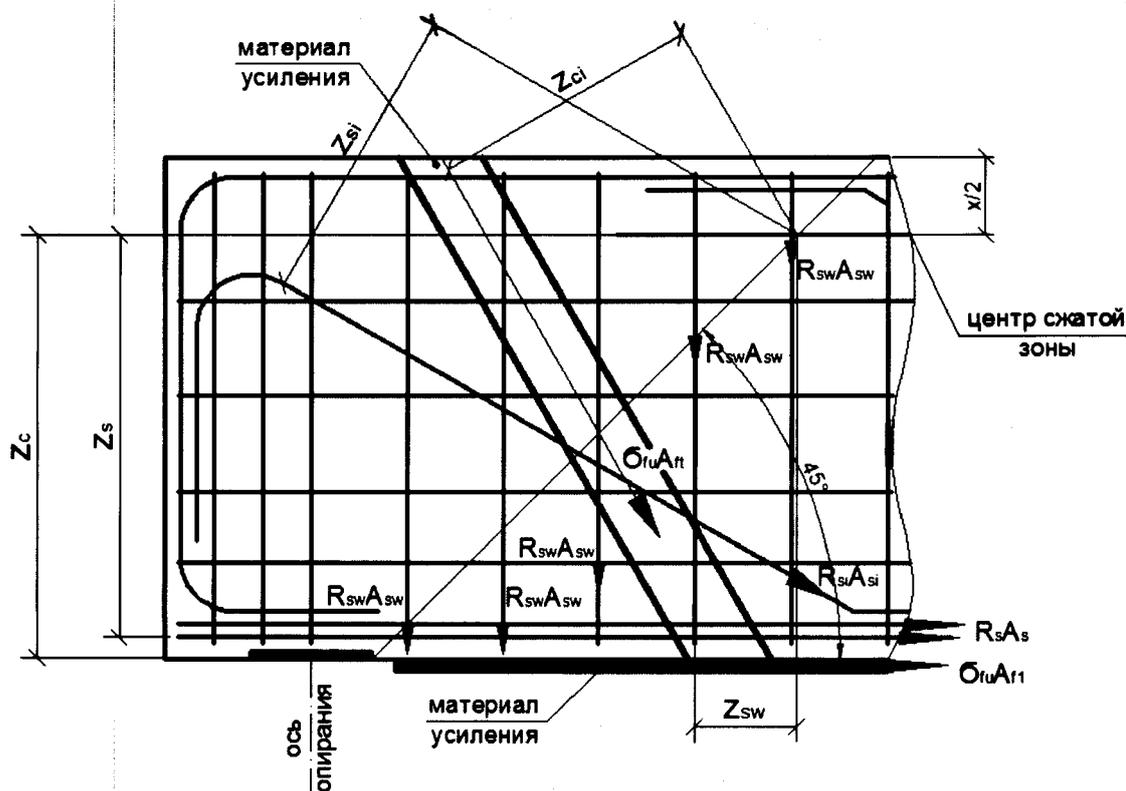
Расчетная схема к определению предельного изгибающего момента в наклонном сечении
